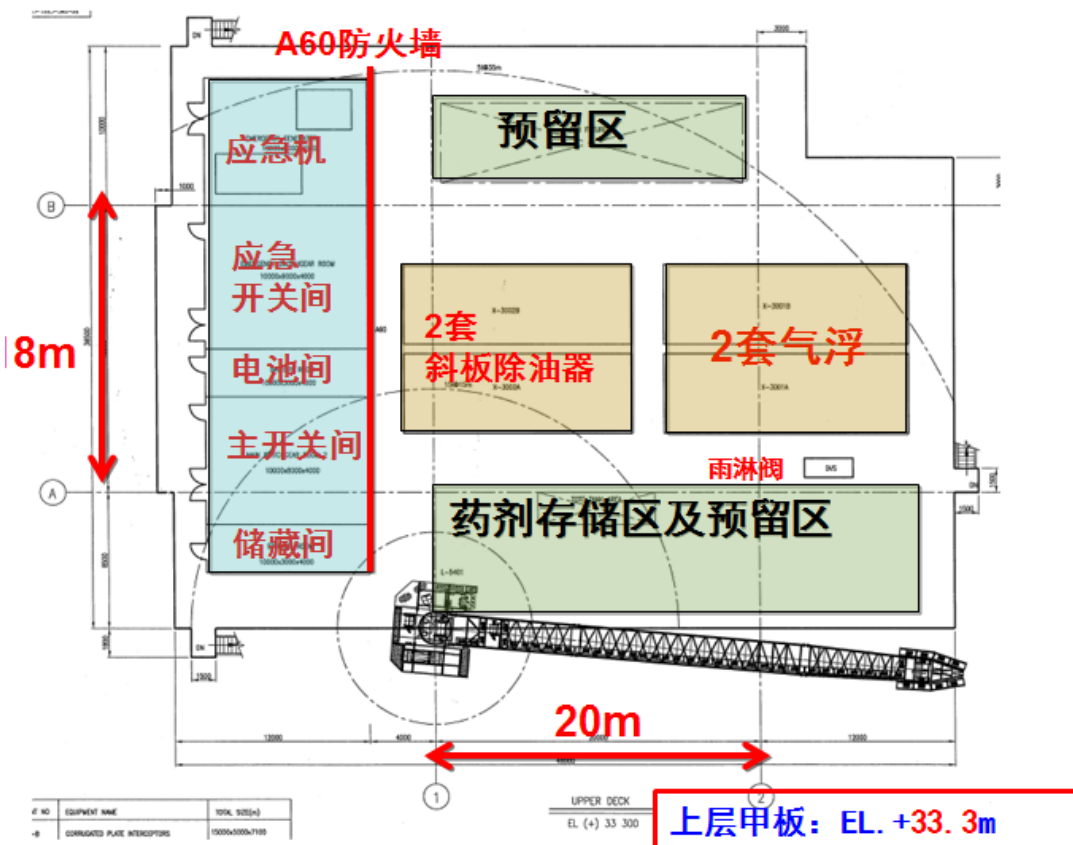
QHD32-6CEPL 平台上层甲板平面布置图
